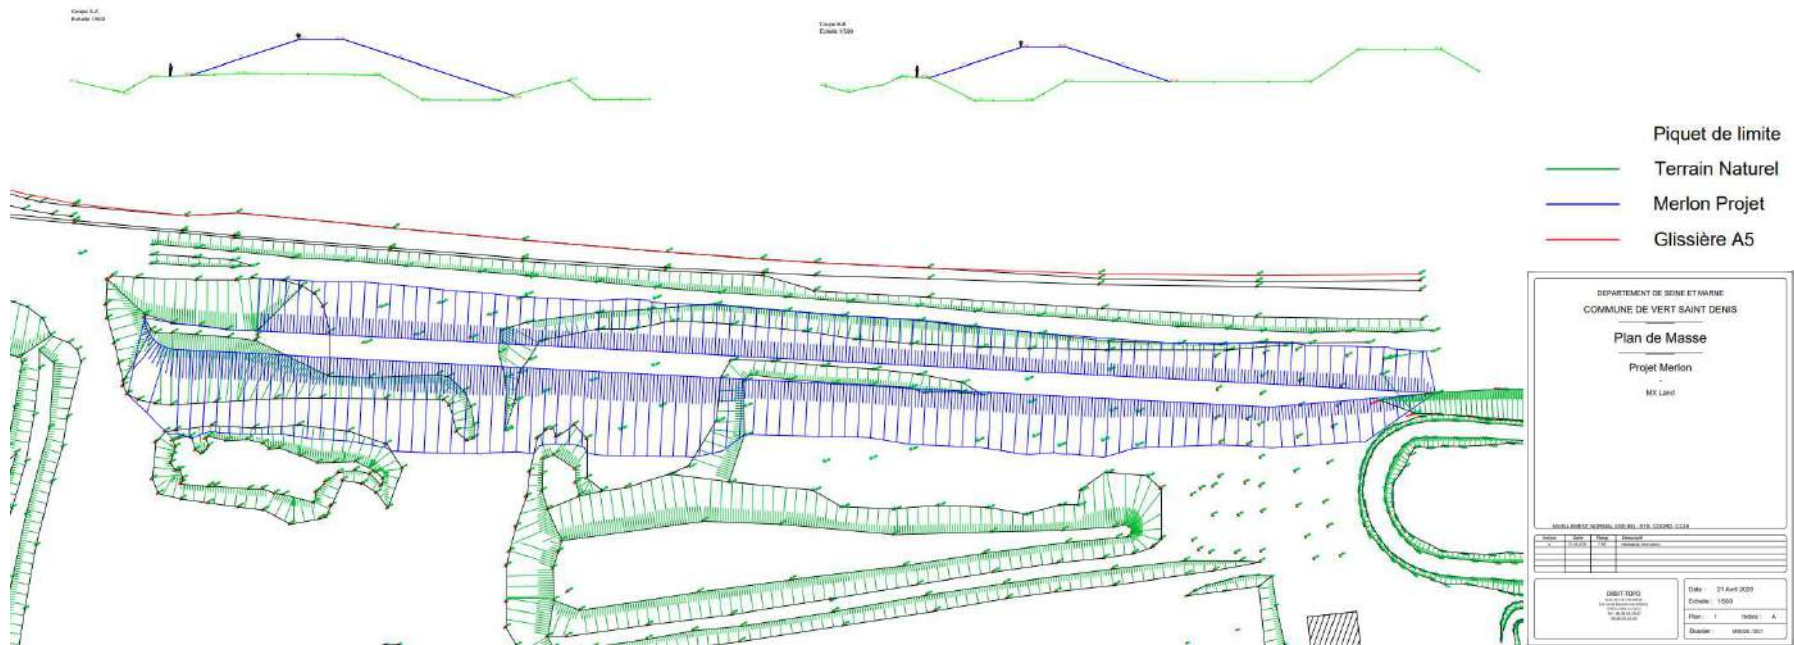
Plan de masse et profils en long du merlon de protection (Source : MX Land)
